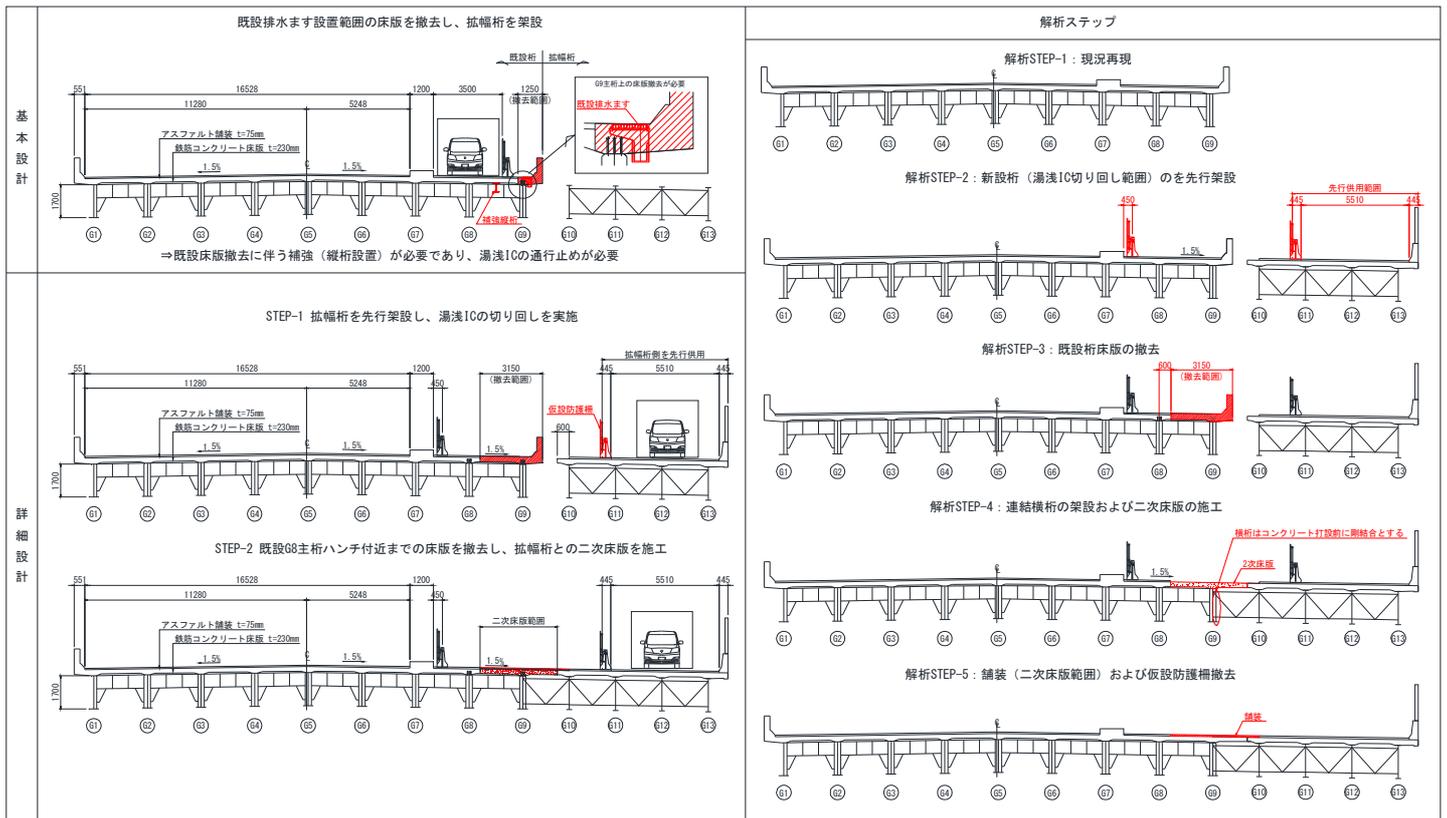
山田高架橋（拡幅部） 拡幅施工ステップ図
